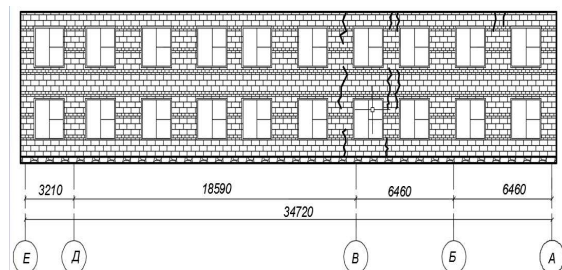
Трещины на фасаде в осях Е-А
